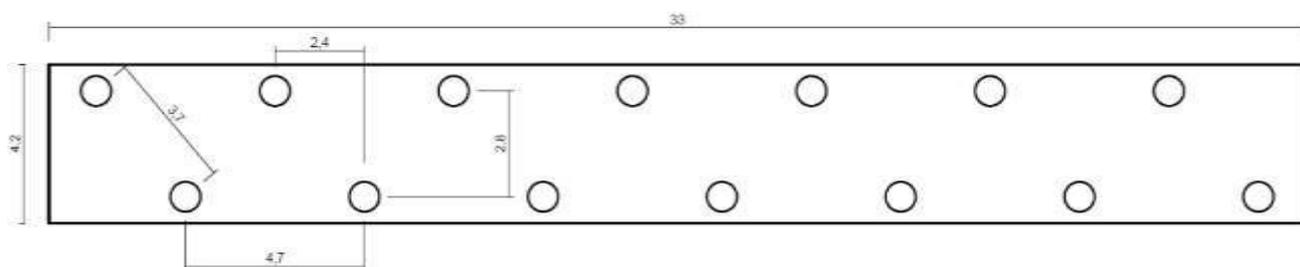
Pianta fondazione muro frangivento su cassa di colmata
